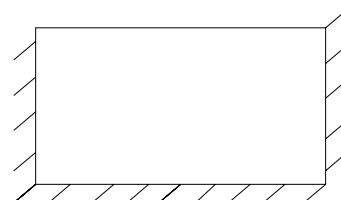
Panel con apoyo horizontal inferior y apoyos verticales laterales.
